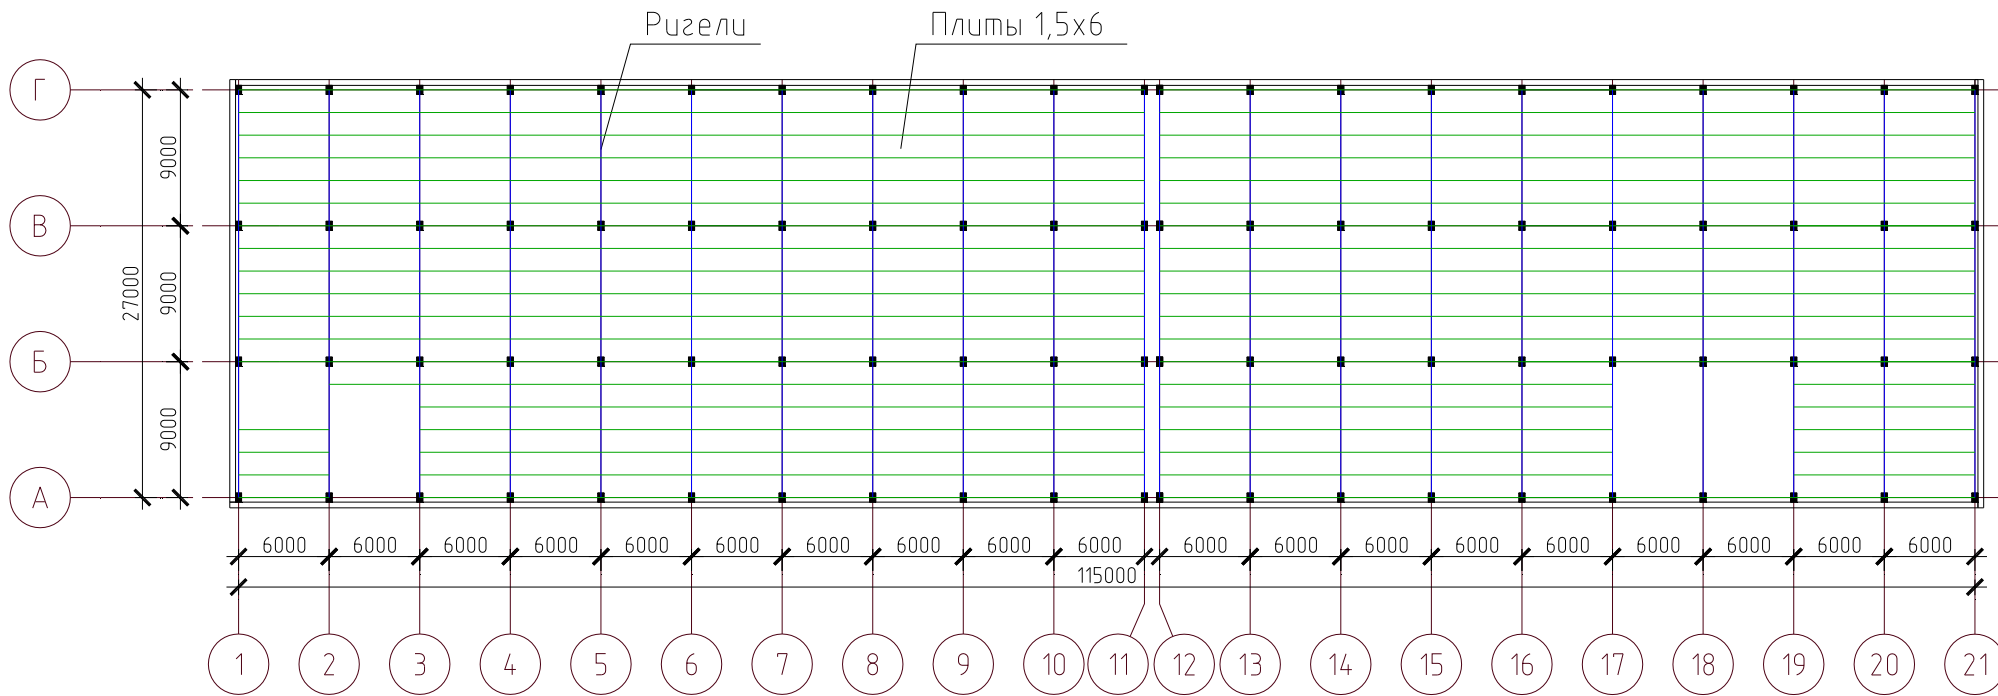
План раскладки ригелей и плит перекрытия над первым этажом на отметке +6.600 м.
